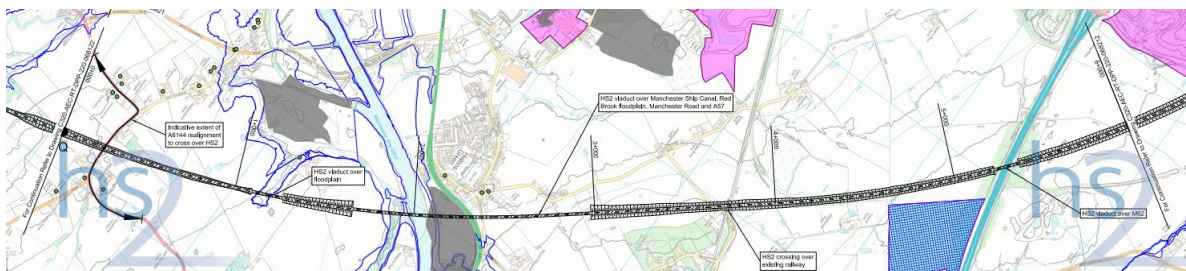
Planta do traçado viaduto sobre Manchester Ship Canal, Manchester Road e a A57 (Unido, HS2 Phase 2b: Warburton to Lowton route sheet 1).
